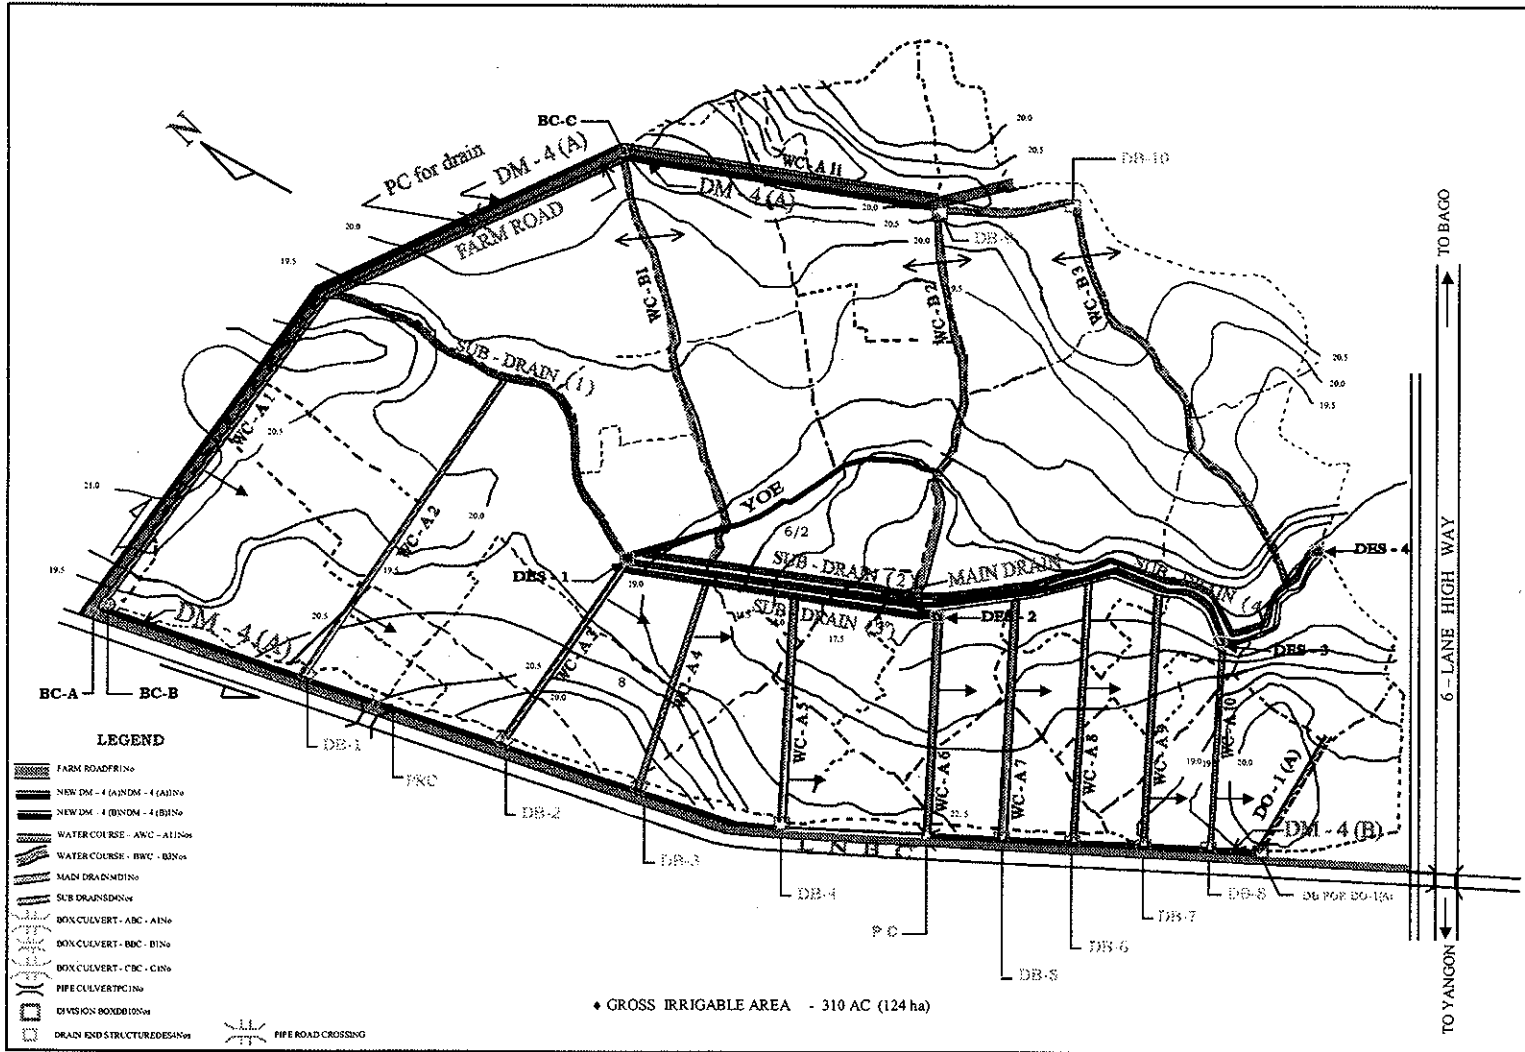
3 試験圃場概要 (エクステンシブタイプ)
